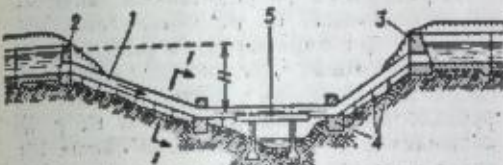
Открытый дюкер на пересечении с глубокой и широкой балкой (схема): 1 — труба; 2 и 3 — оголовки; 4 — опоры; 5 — мостовой переход.
